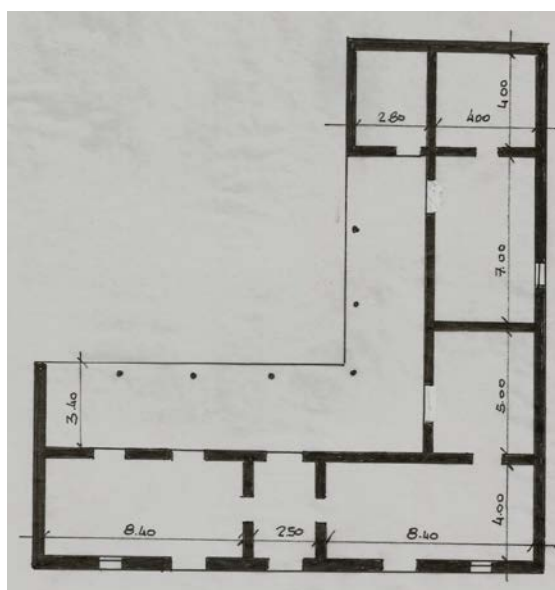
Planta de la antigua escuela de Bajo Carrizal
